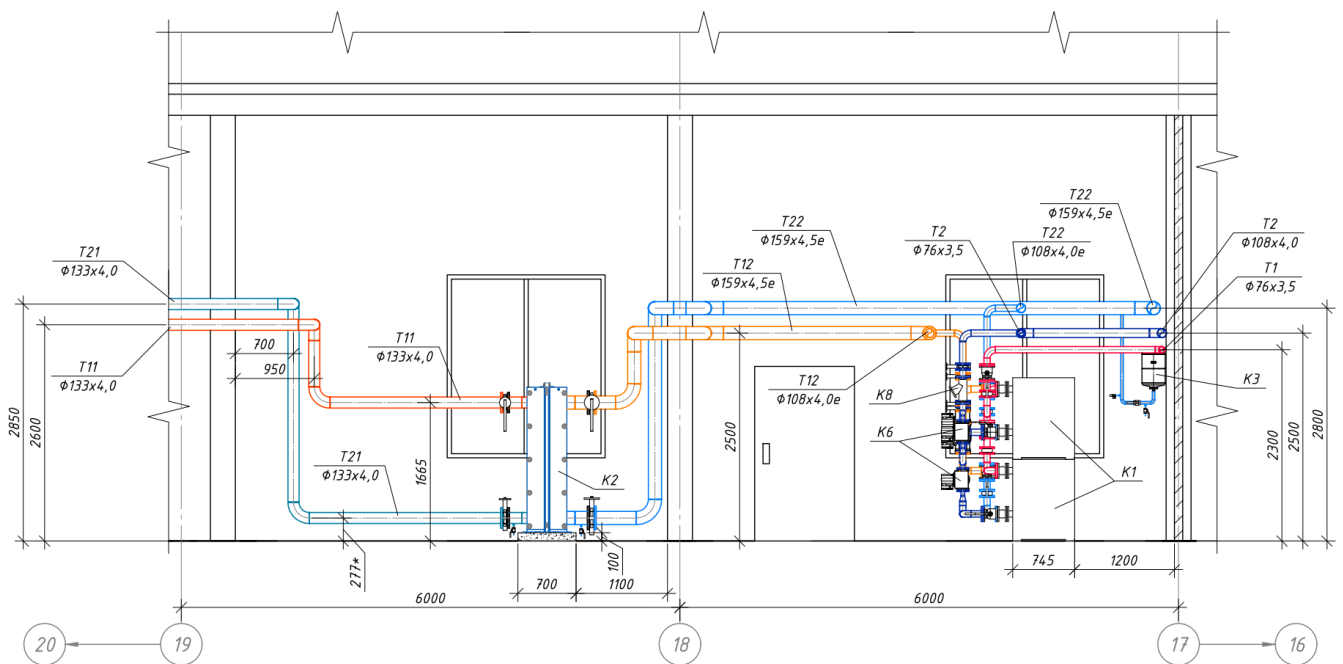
Розташування обладнання та трубопроводів. Розріз 2-2
